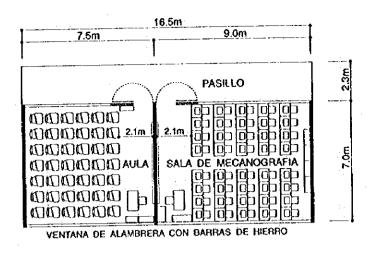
PLANTA DEL EDIFICIO DE AULAS
